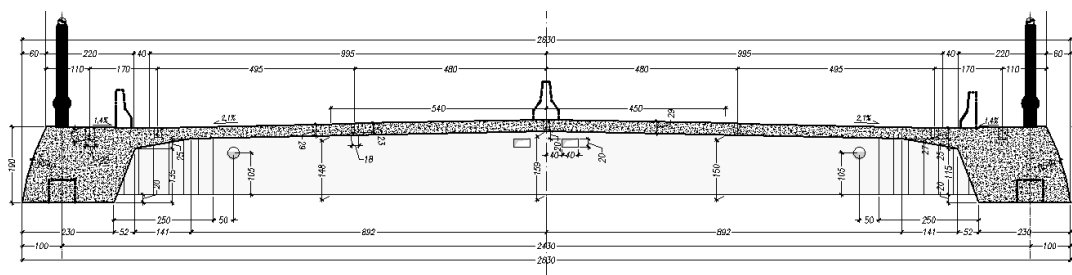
Seção transversal com vigas e laje de concreto - Ponte Cardeal Dom Eugênio Salles no Rio de Janeiro
